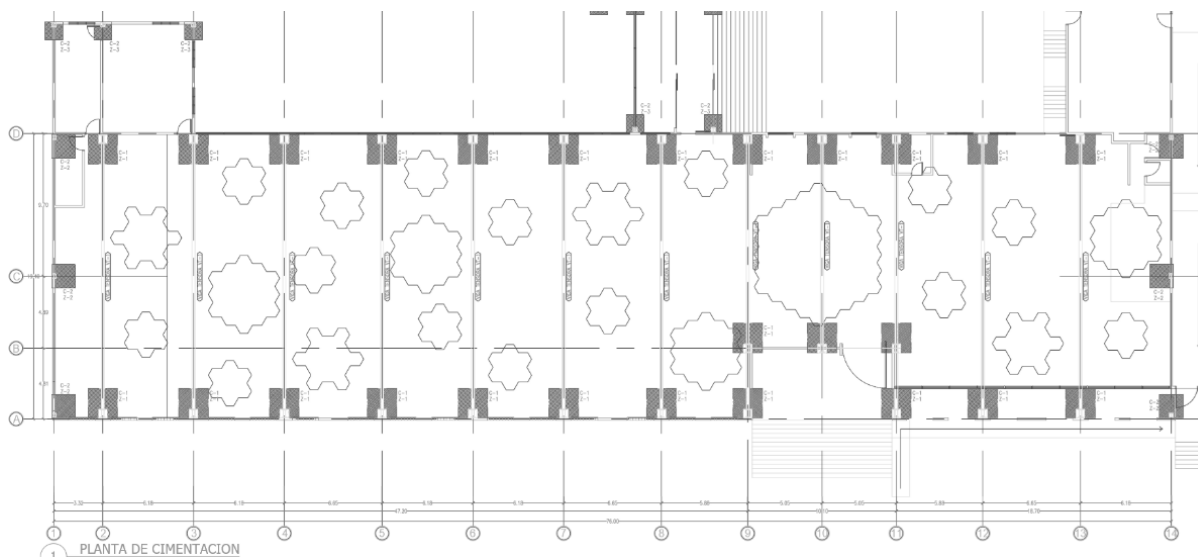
Plano de Cimentación de Estructura Existente de la Biblioteca
